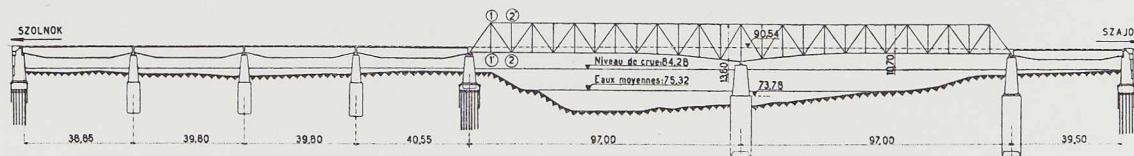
Elevation du pont sur la Tisza, à Szolnok, les détails des coupes 11' et 22' sont donnés sur la figure 615.
